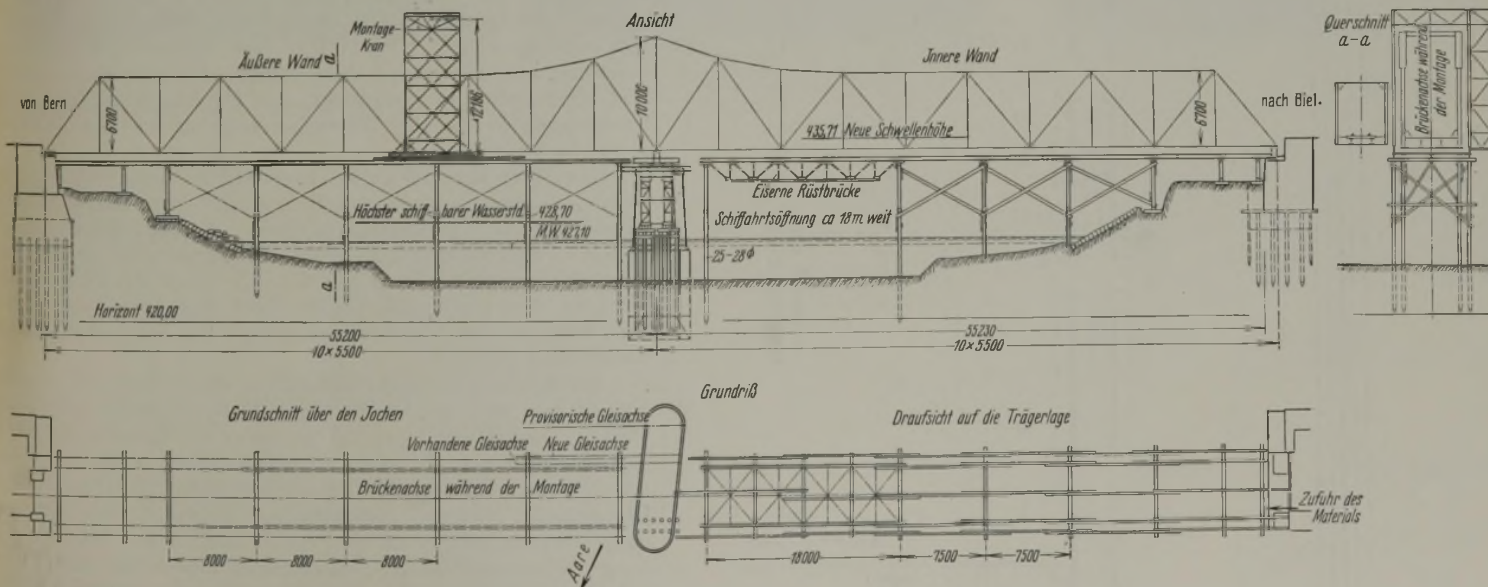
Trägerschema und Aufstellungsgerüst für die neuen Überbauten aus St Si.
